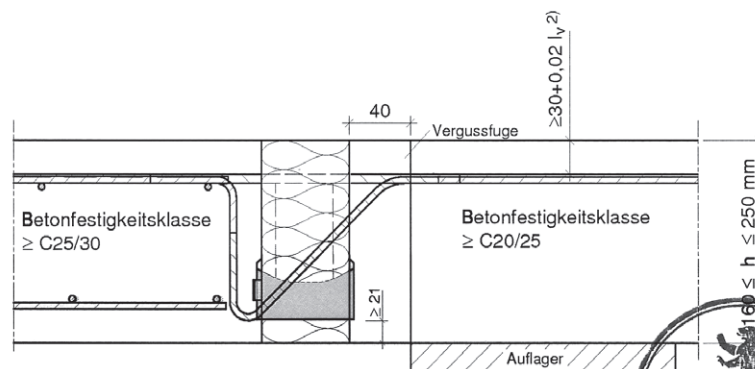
Beispiel Schöck Isokorb Typ RK-240 in eingebautem Zustand mit Vergussfuge
